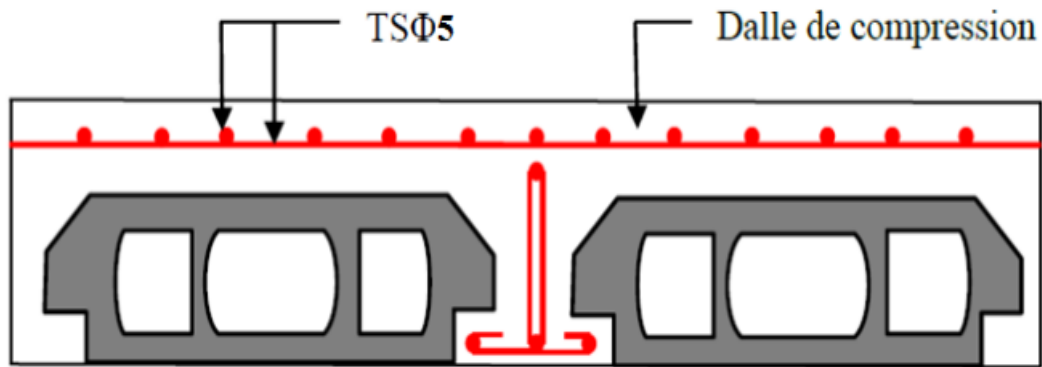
Schéma de ferrailage de la dalle de compression.
